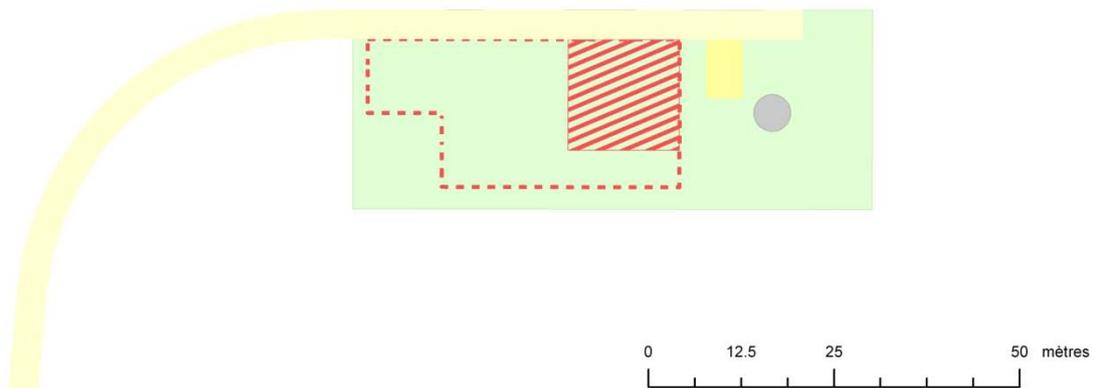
schéma de principe d'une place d'installation de chantier restituée (extrait du plan de situation de l'éolienne T5, (source : ATB).
